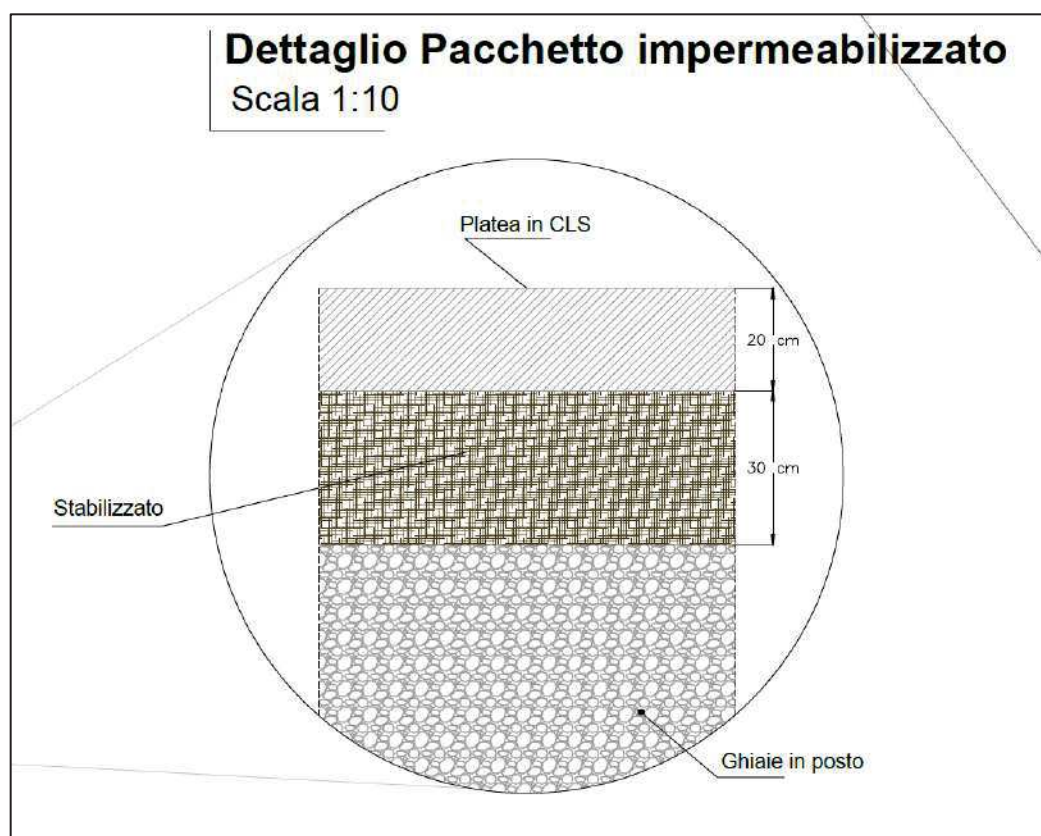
Estratto TAV_03_REV_2_STATO DI PROGETTO
